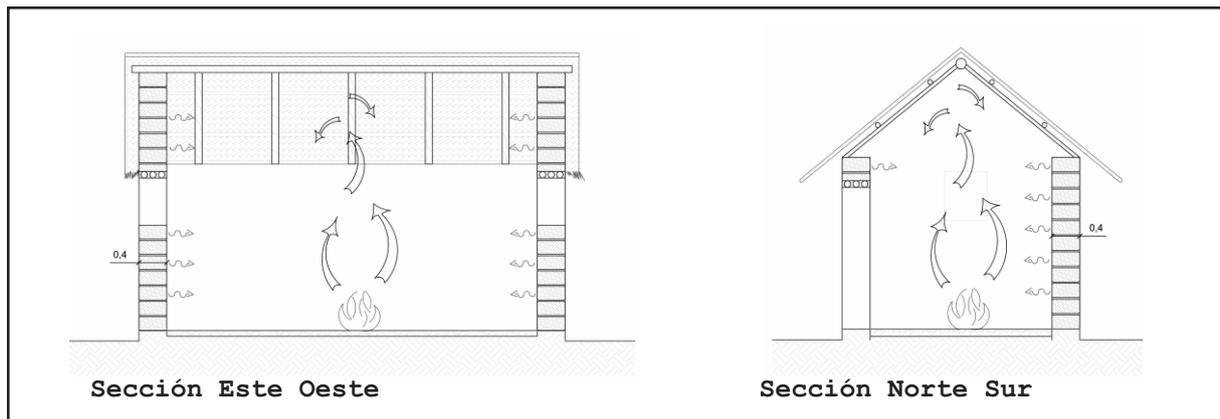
Esquema Planta y Alzado vivienda Tiawanaku. Elaboración Propia.
